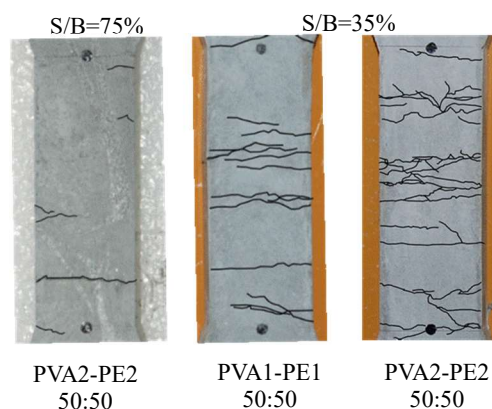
繊維長さおよび砂結合材比を変更した供試体のひび割れ状況
